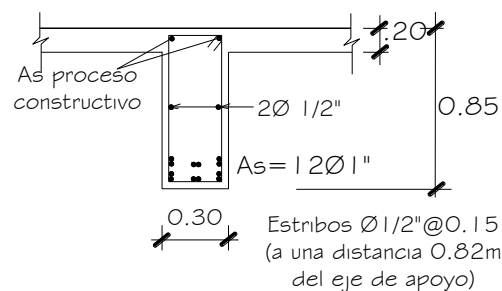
Armadura longitudinal y transversal en la viga interior
